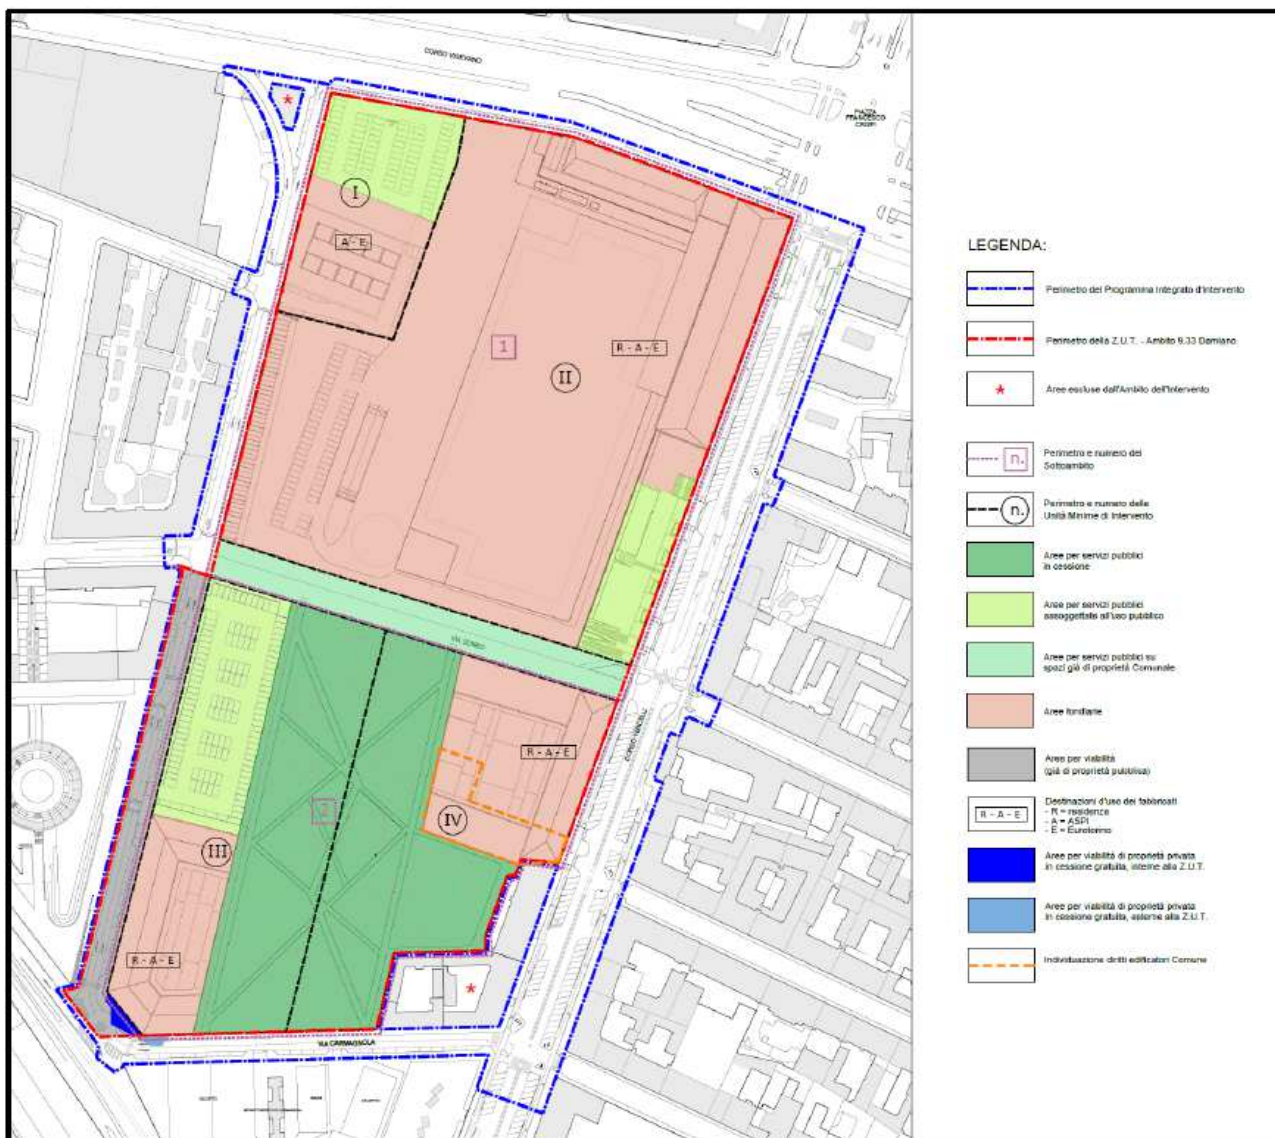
Vista planimetrica dell'area allo stato di progetto con l'indicazione delle UMI (stralcio da documento "VERIFICA DI COMPATIBILITA")
